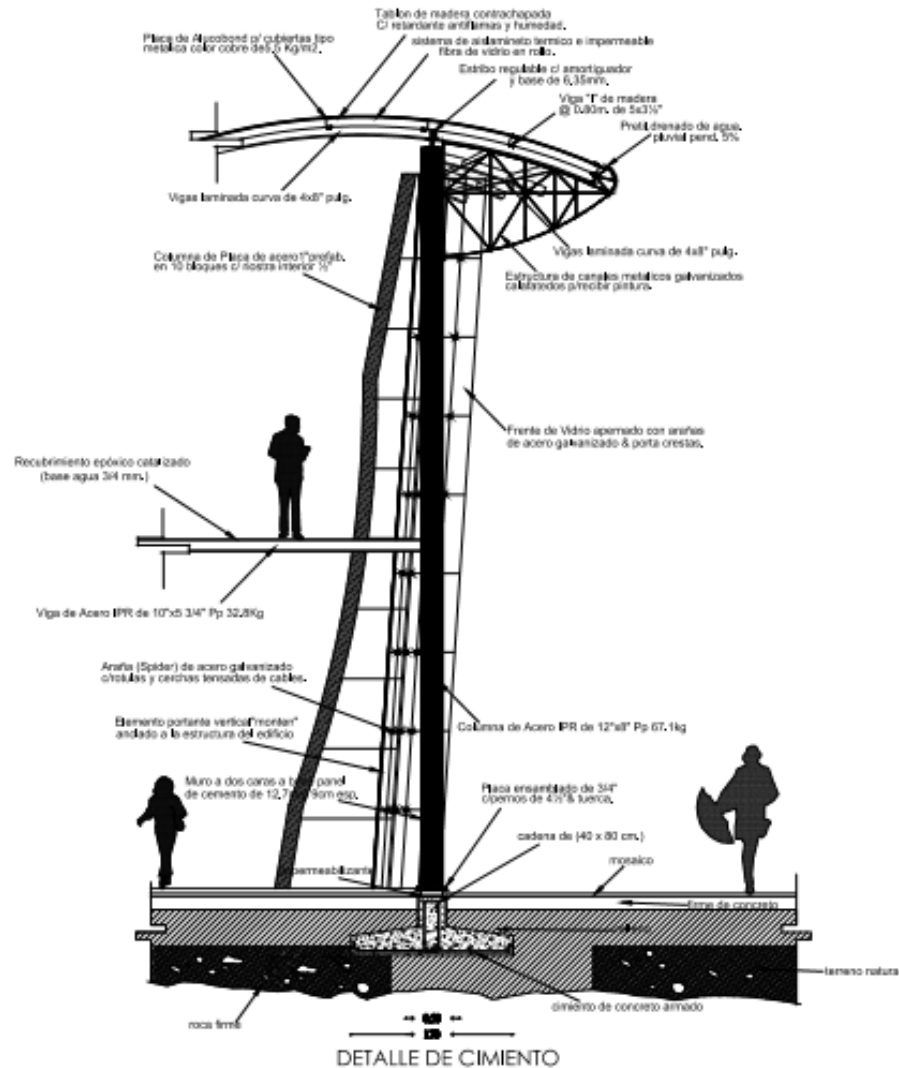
IMAGEN Detalle Estructural para fachada de Nave de Cocción.
